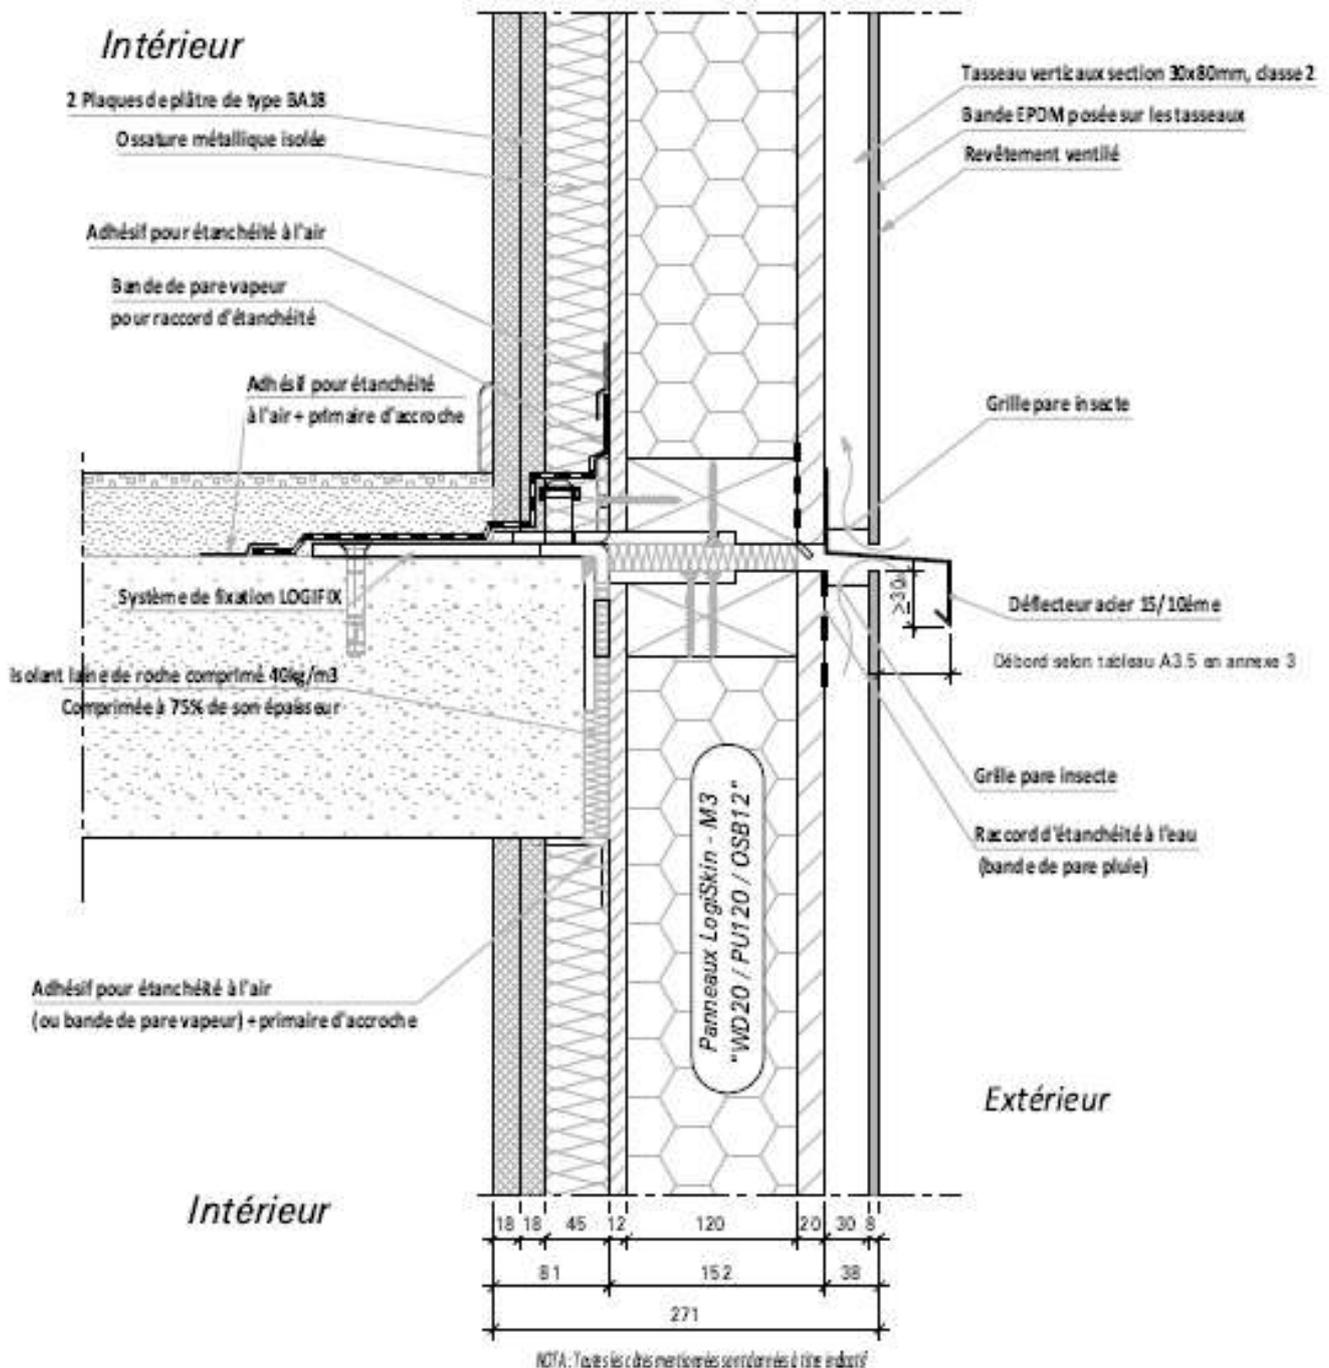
Détail CV-2.2 – jonction plancher (mode de pose 2.2)
